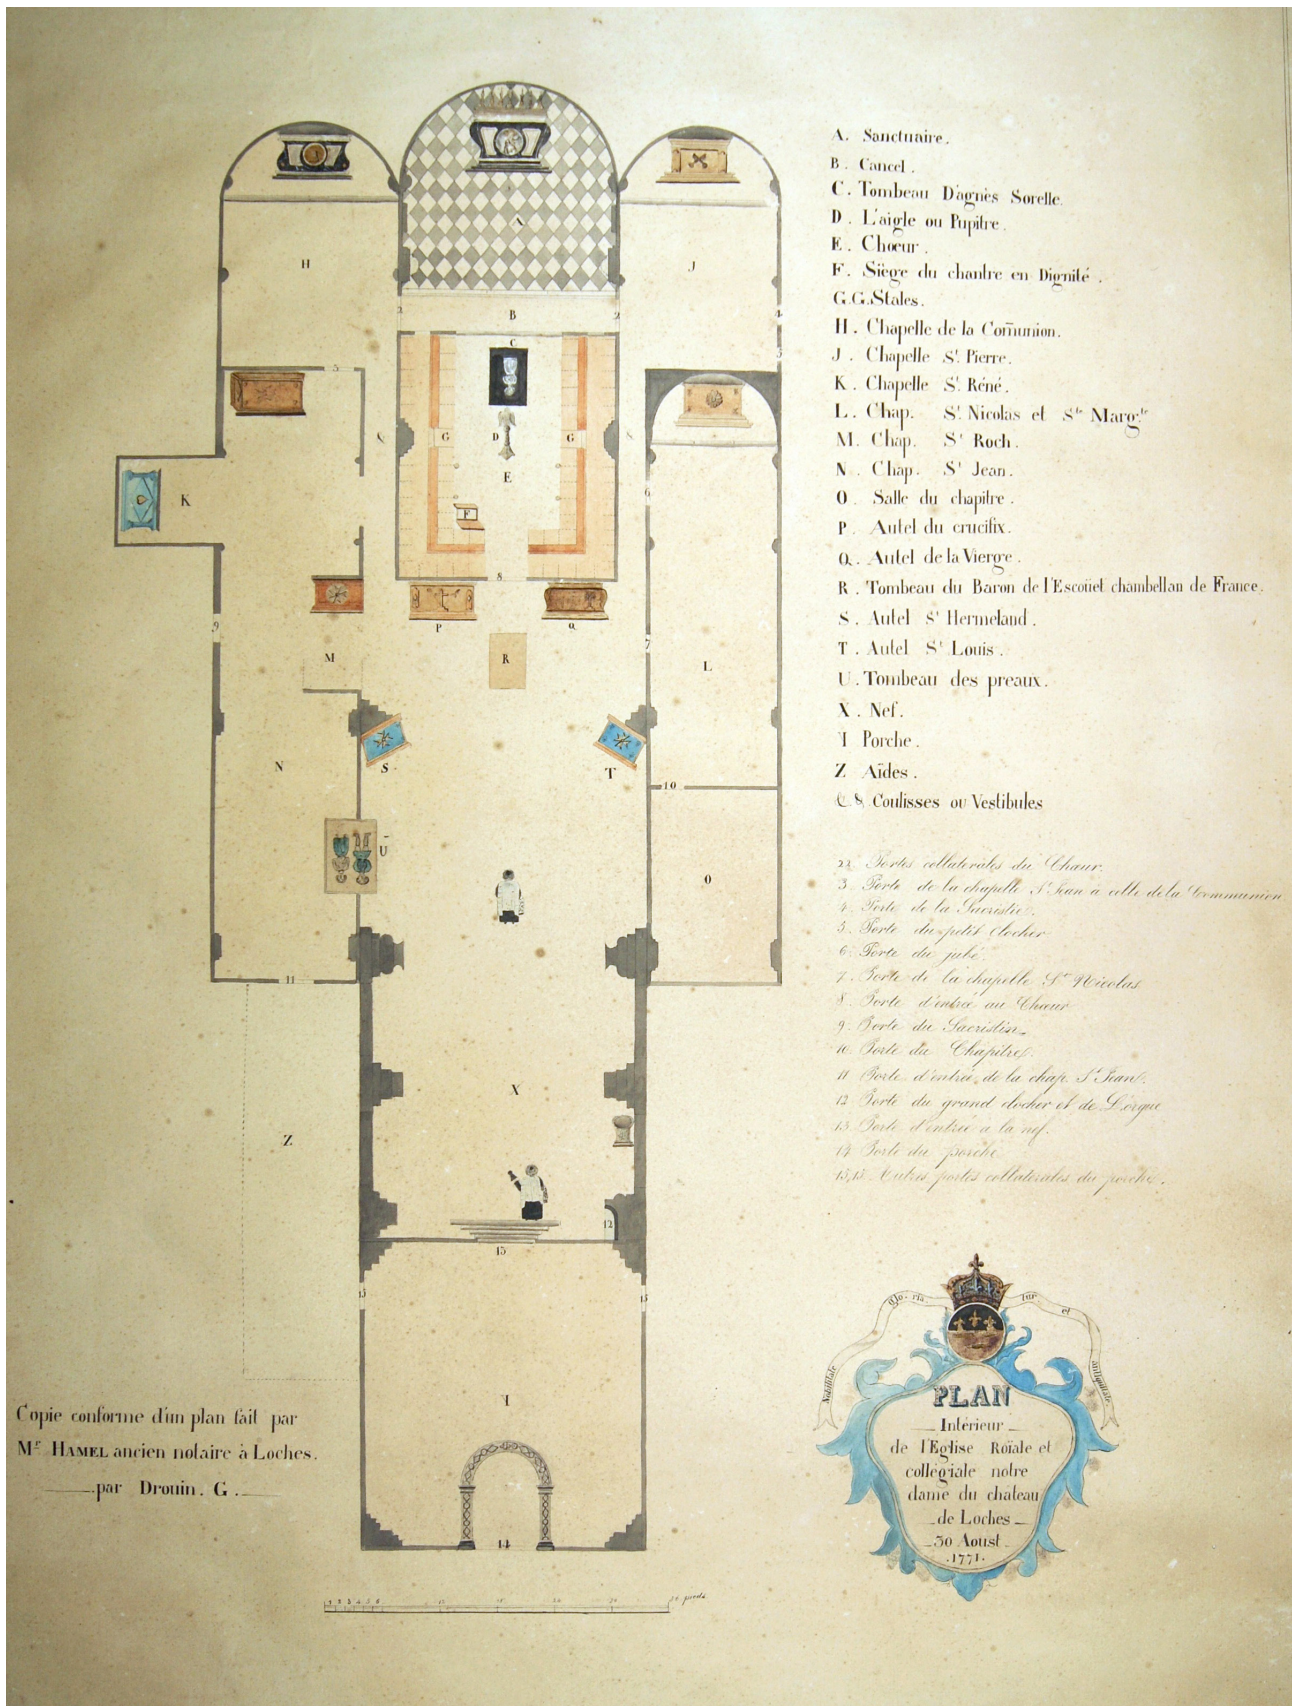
Plan de la collégiale de 1771 (par G. Drouin pour le notaire Hamel (BM Loches))
